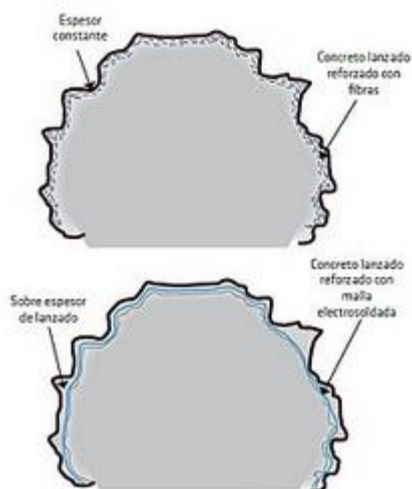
"Hormigón reforzado con fibra", publicación Sika 2012.
